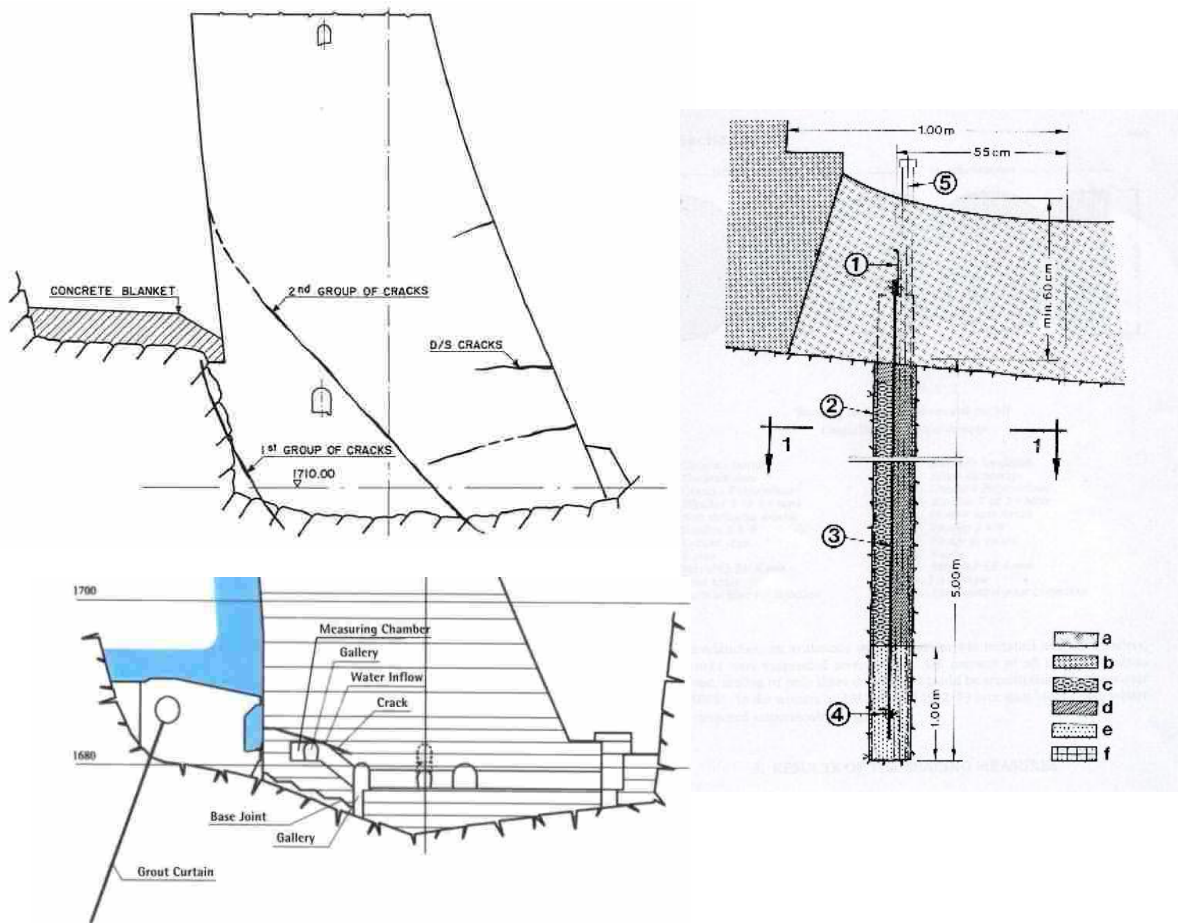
Kölnbrein. Patron de fissuration (gauche). Schlegeis. Ecran étanche sous l'ouvrage (centre). Zillergrundl. Patron de fissuration et joint de base mis en pression (droite).
